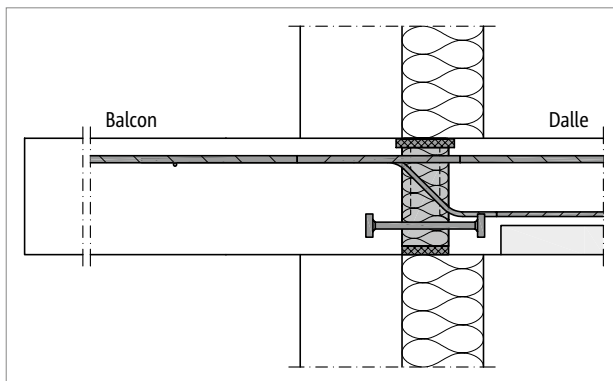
Schöck Rutherma® T type DB : liaison pour façade en béton armé et plancher constitué de prédalles
